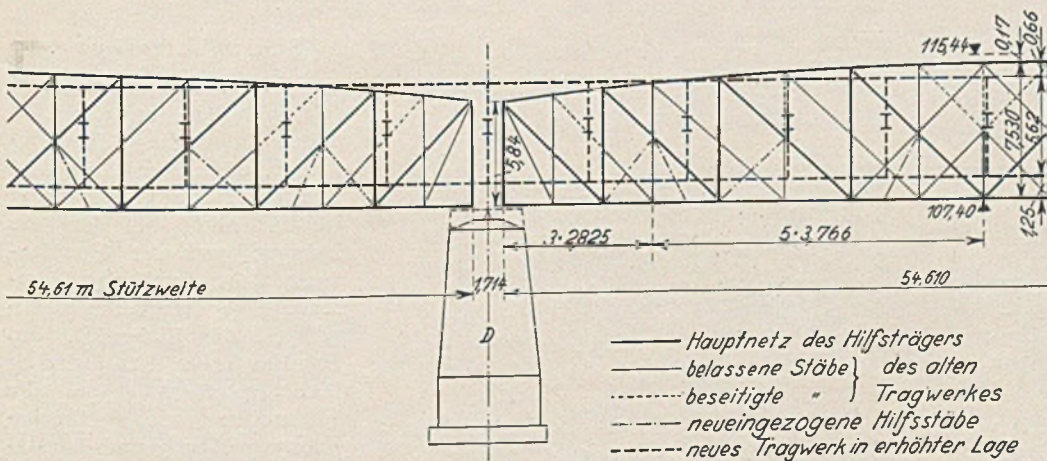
Abänderung des linken Hauptträgers für den Einbau der neuen Brücke.
